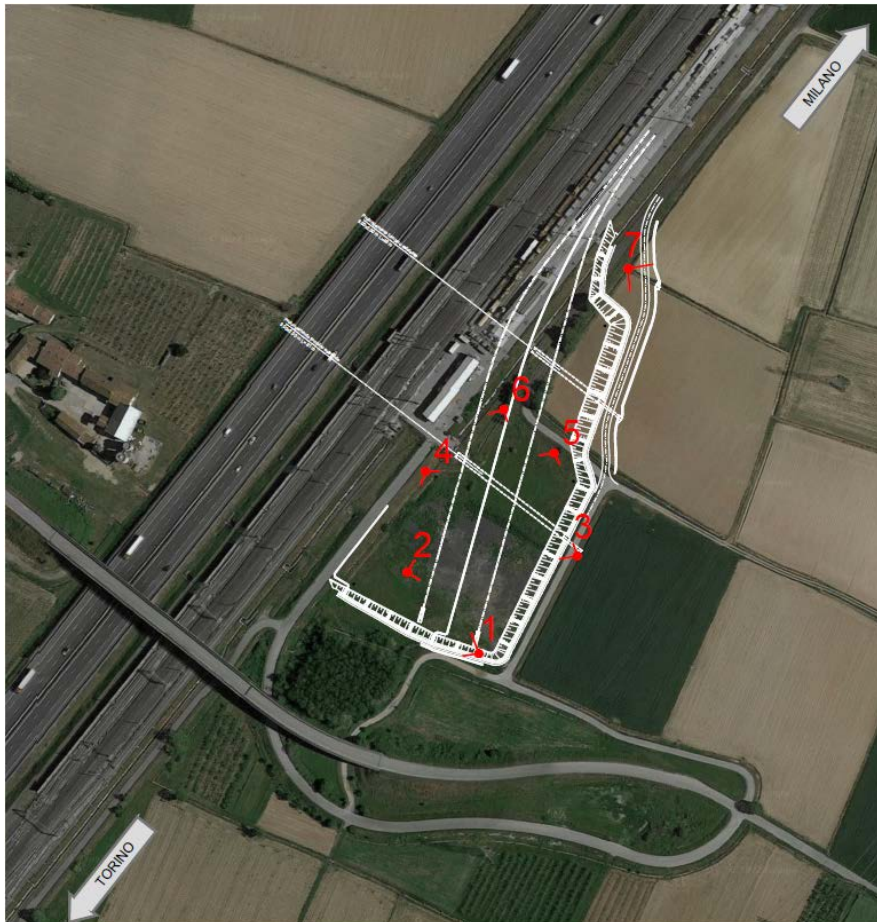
Planimetria di progetto su ortofoto con indicazione delle immagini rappresentative dello stato di fatto (ALL_06)
